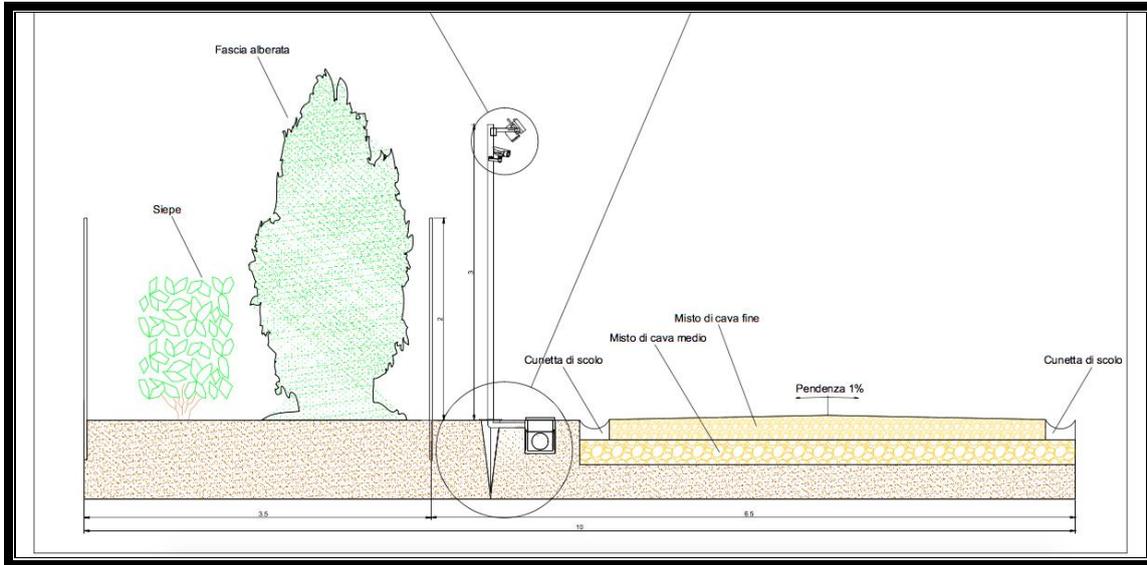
SCHEMA DEL PROGETTO DI MITIGAZIONE
